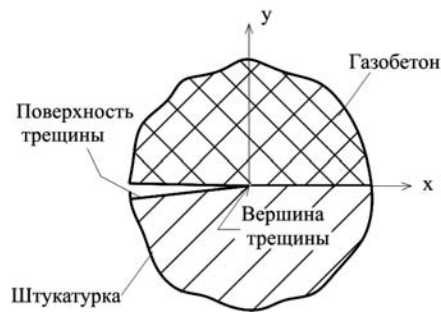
Характер трещинообразования в контактной зоне «газобетонная кладка - штукатурное покрытие»
